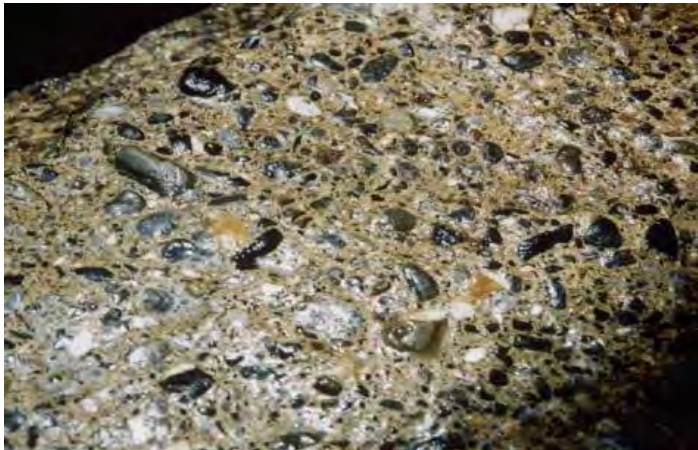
Oberflächlicher Verschleiß („Waschbeton“) an Beton mit einem Größtkorn von 32 mm an einer Wehrkrone [Lit 48]
